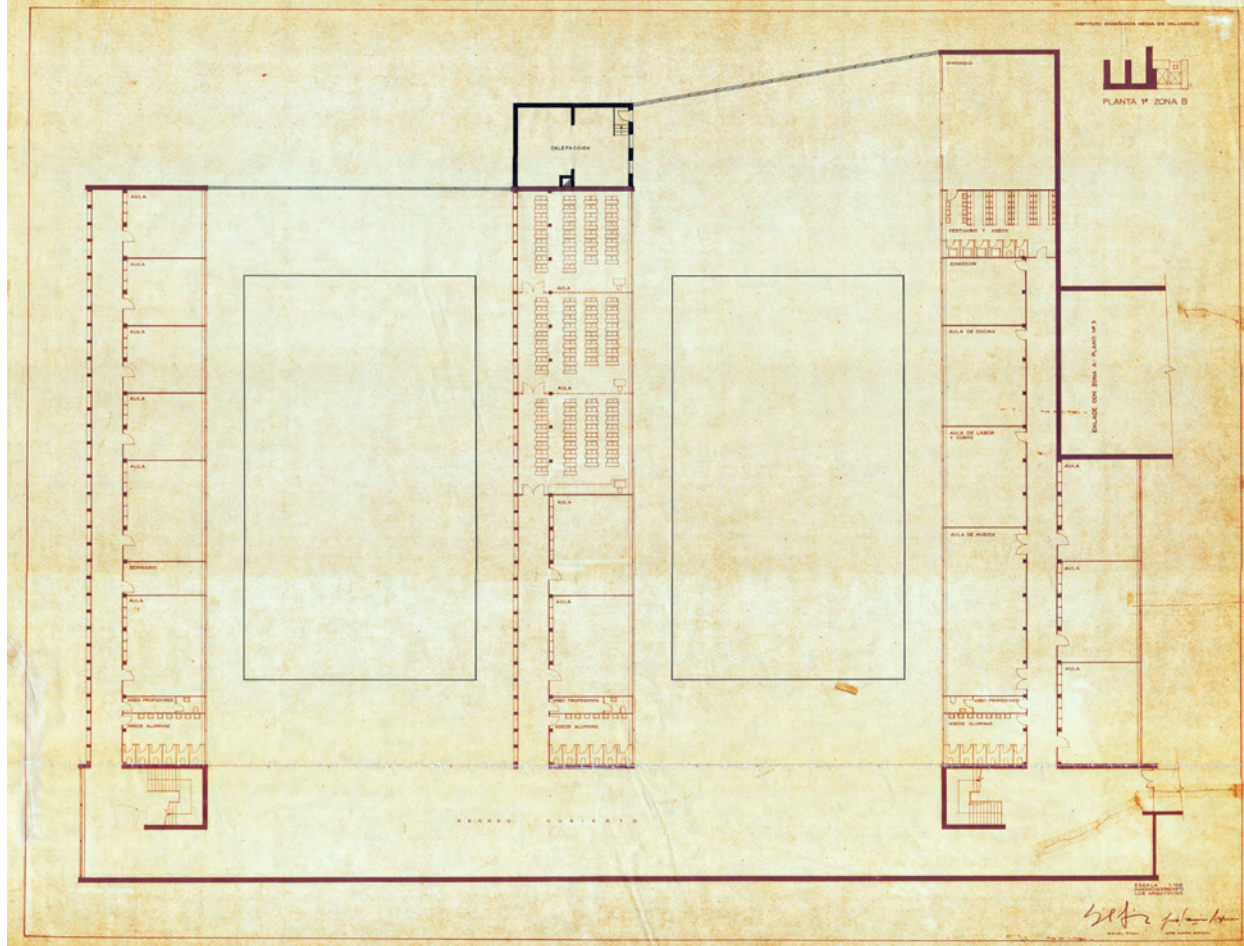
Planta primera Instituto Núñez de Arce. AFF 136
